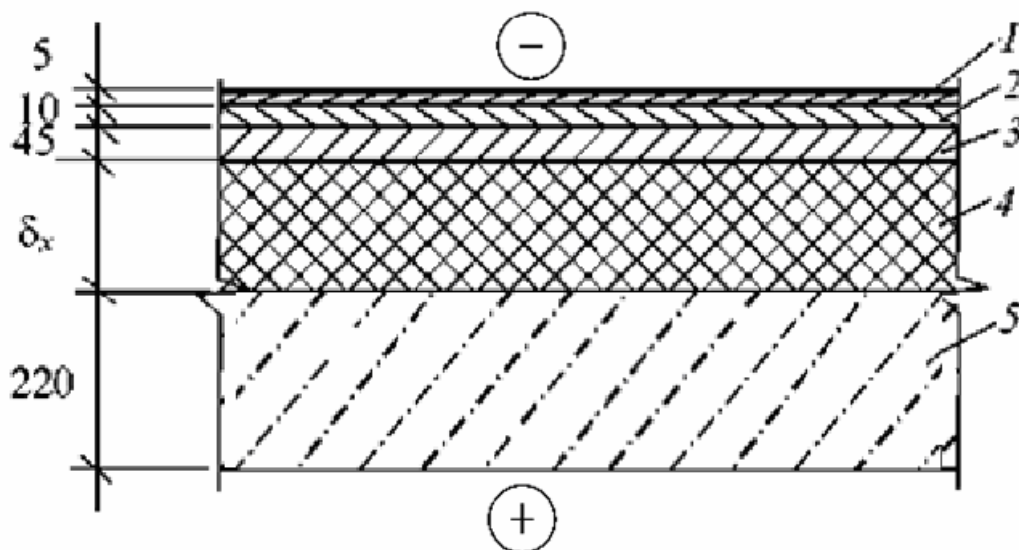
Вариант 1-й конструкции перекрытия над неотапливаемым подвалом:
